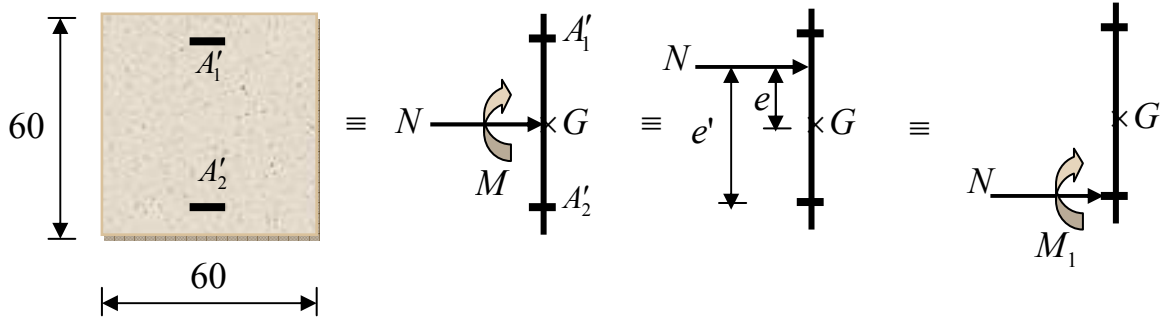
Position de N_1 et M_1 sur la section transversale.
